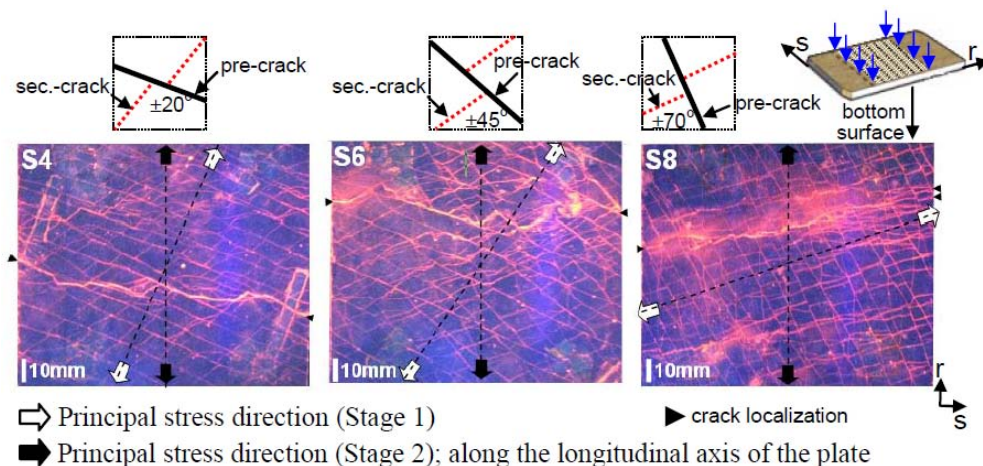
主応力軸回転による多方向ひび割れの発生¹⁶⁾
